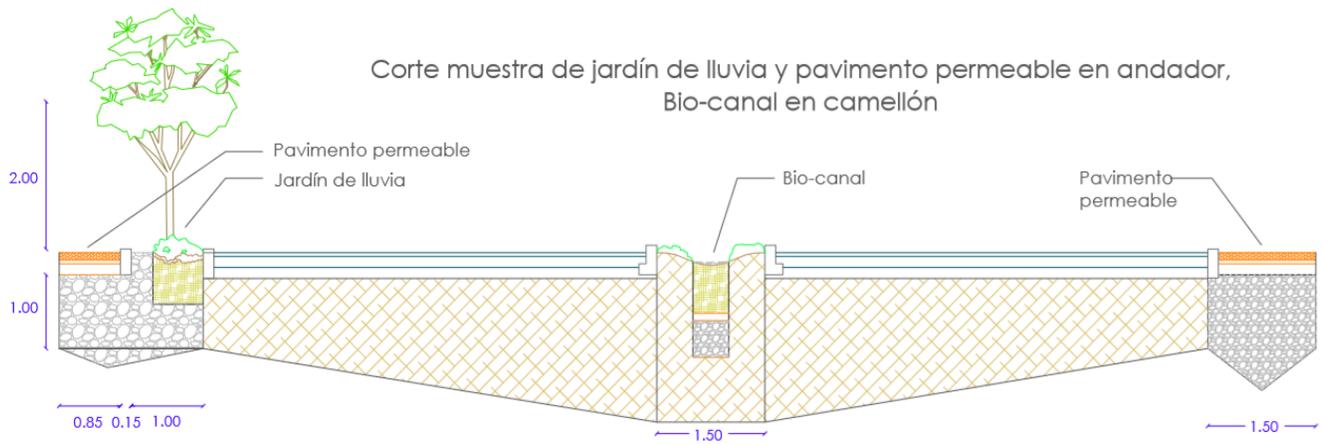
Corte muestra de corredor verde con Jardín de lluvia y pavimento permeable en andadores y Bio-canal en camellón. Fuente: elaboración propia
